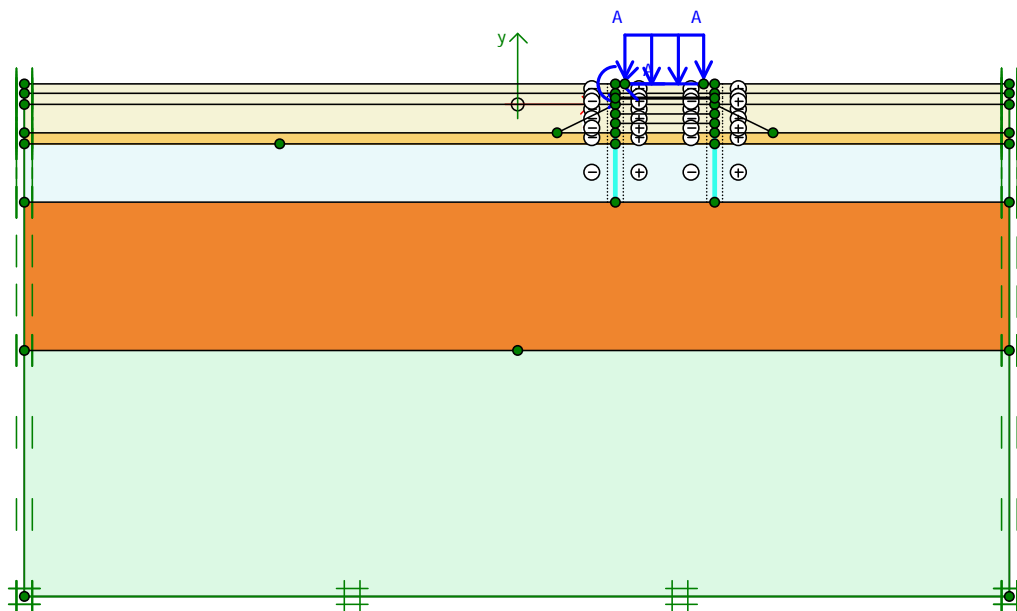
Sezione di calcolo B-B spalla sinistra con Plaxis
